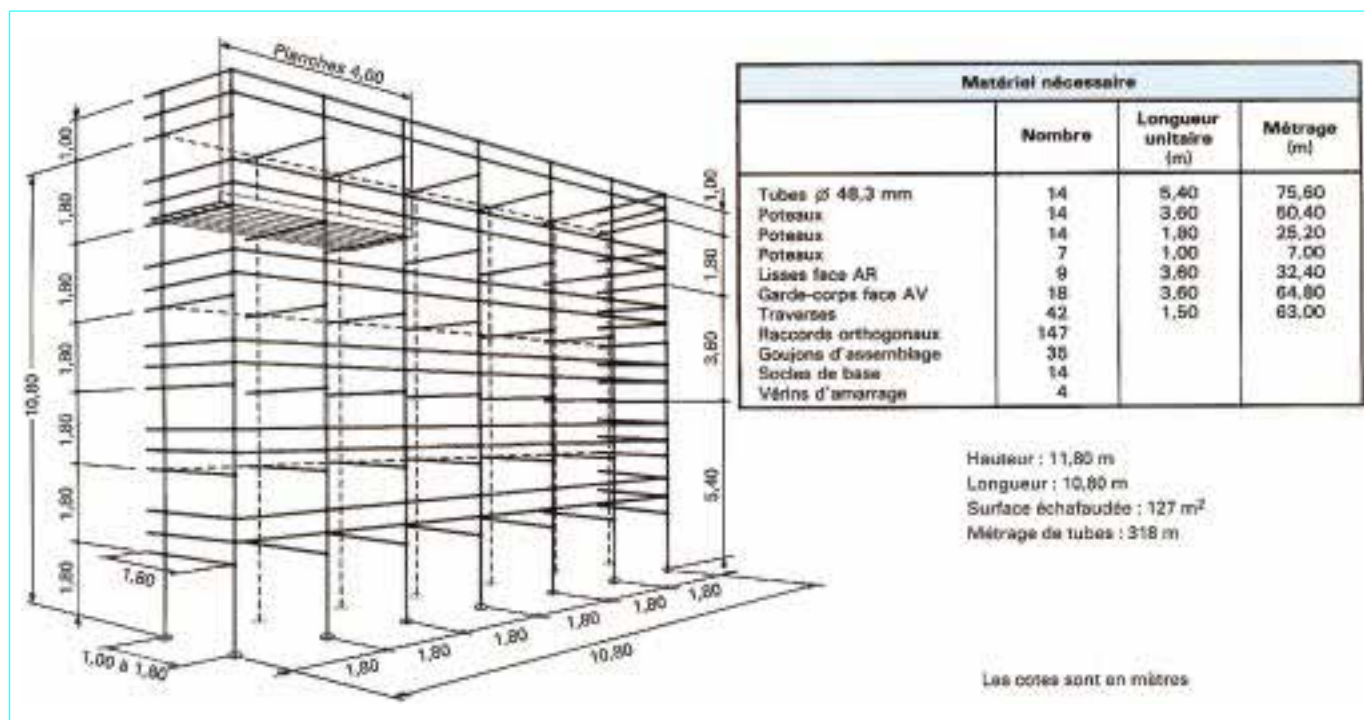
Échafaudage de façade en appui au sol, non recouvert
